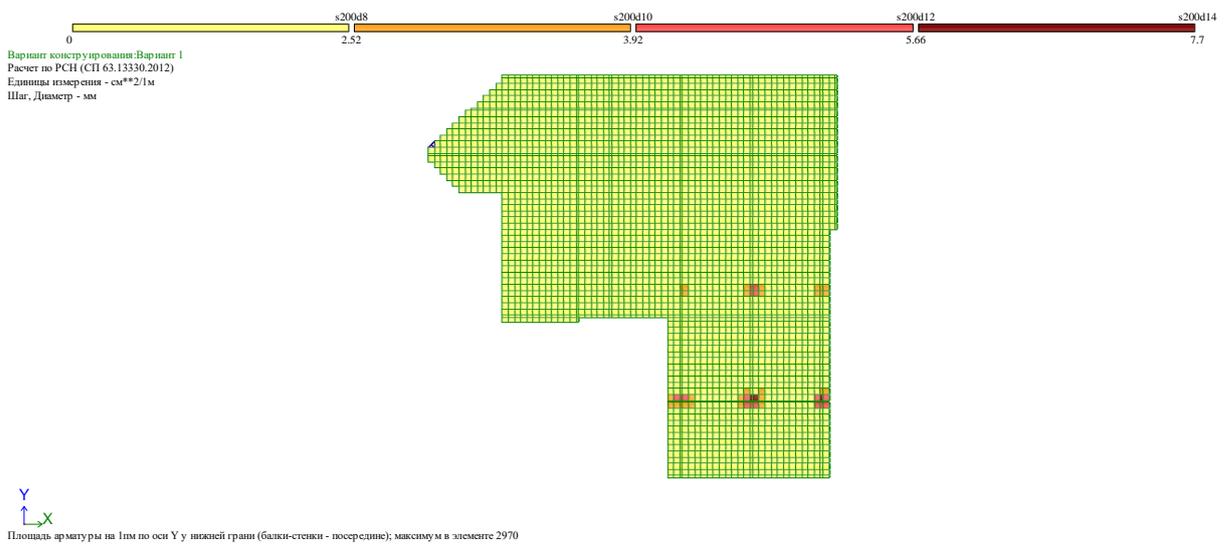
Подбор нижней продольной арматуры плиты по оси Y
